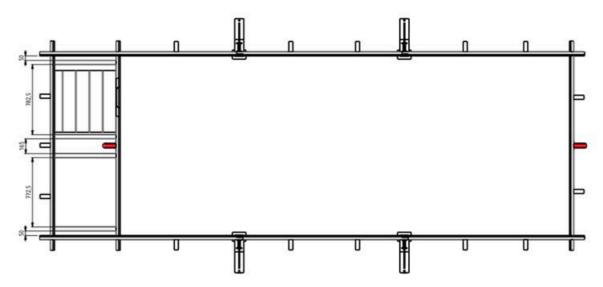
Aplicación de zapatos para la fuerza madera pierna
